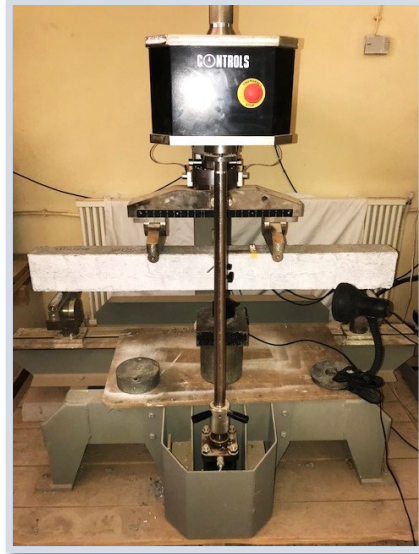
Essai de flexion simple quatre points sur les poutres 10*15-140cm³.
